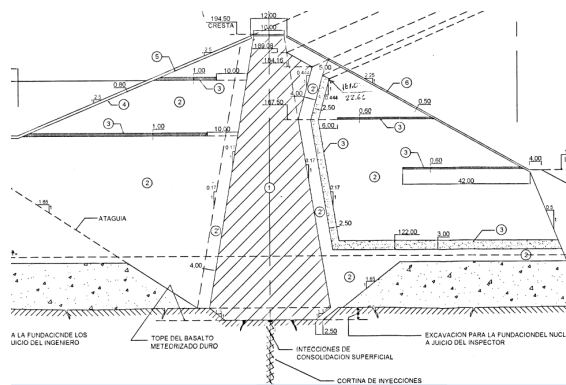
Sección transversal detalle del núcleo impermeable.
